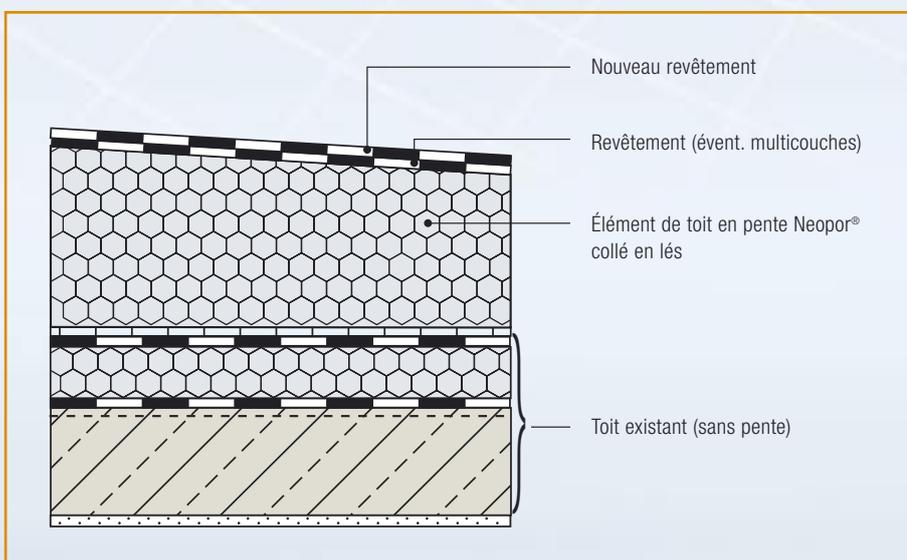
Toit existant sans pente en Neopor® – éléments de pente et revêtement de toit renoué.
